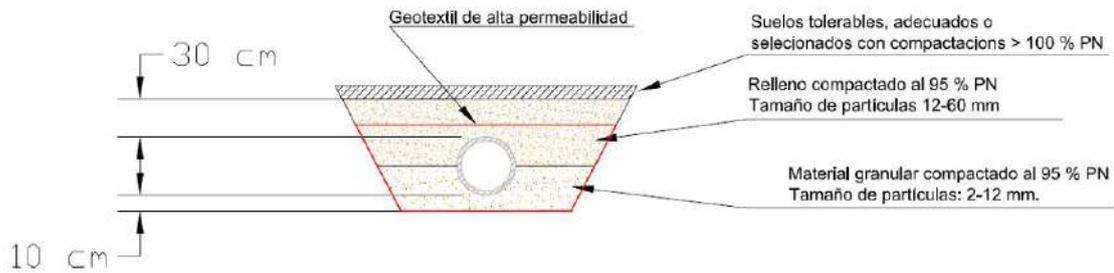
Detalle de la estructura de drenaje bajo pista
